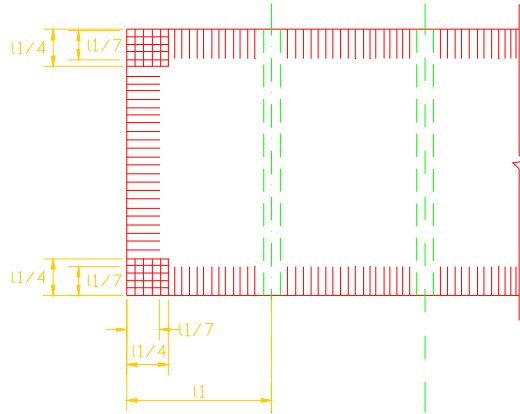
嵌固在承重砖墙内的板上部构造钢筋焊接网时应将上部钢筋弯折(图 5.2.5)。
